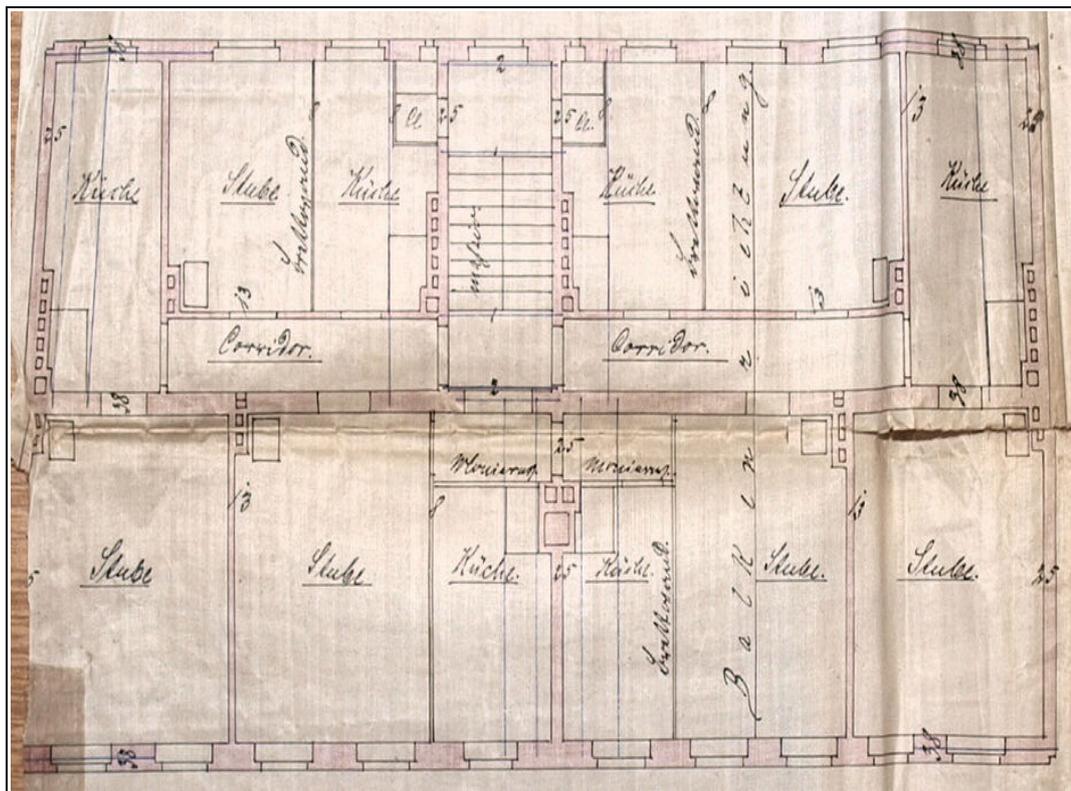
Grundriss 3./4. OG im QG
